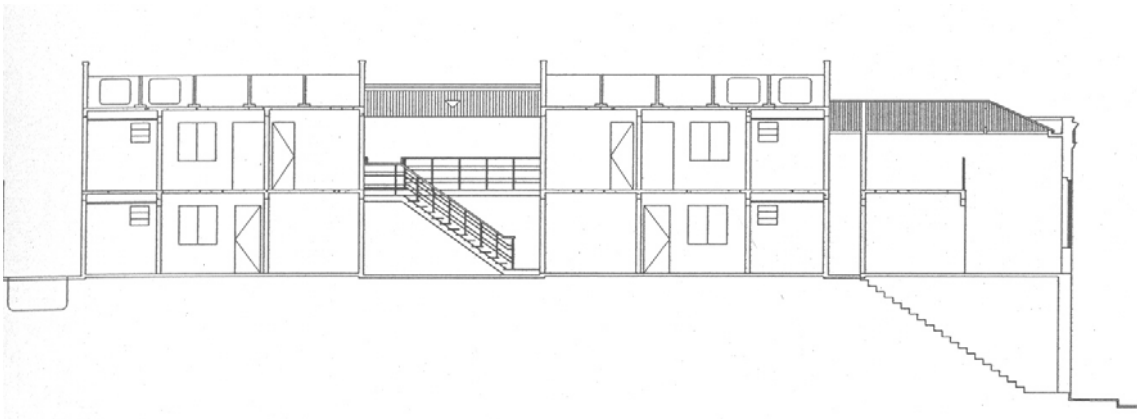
Rua do Livramento, 147 – Corte longitudinal (SECRETARIA, 2000, p. 53).
